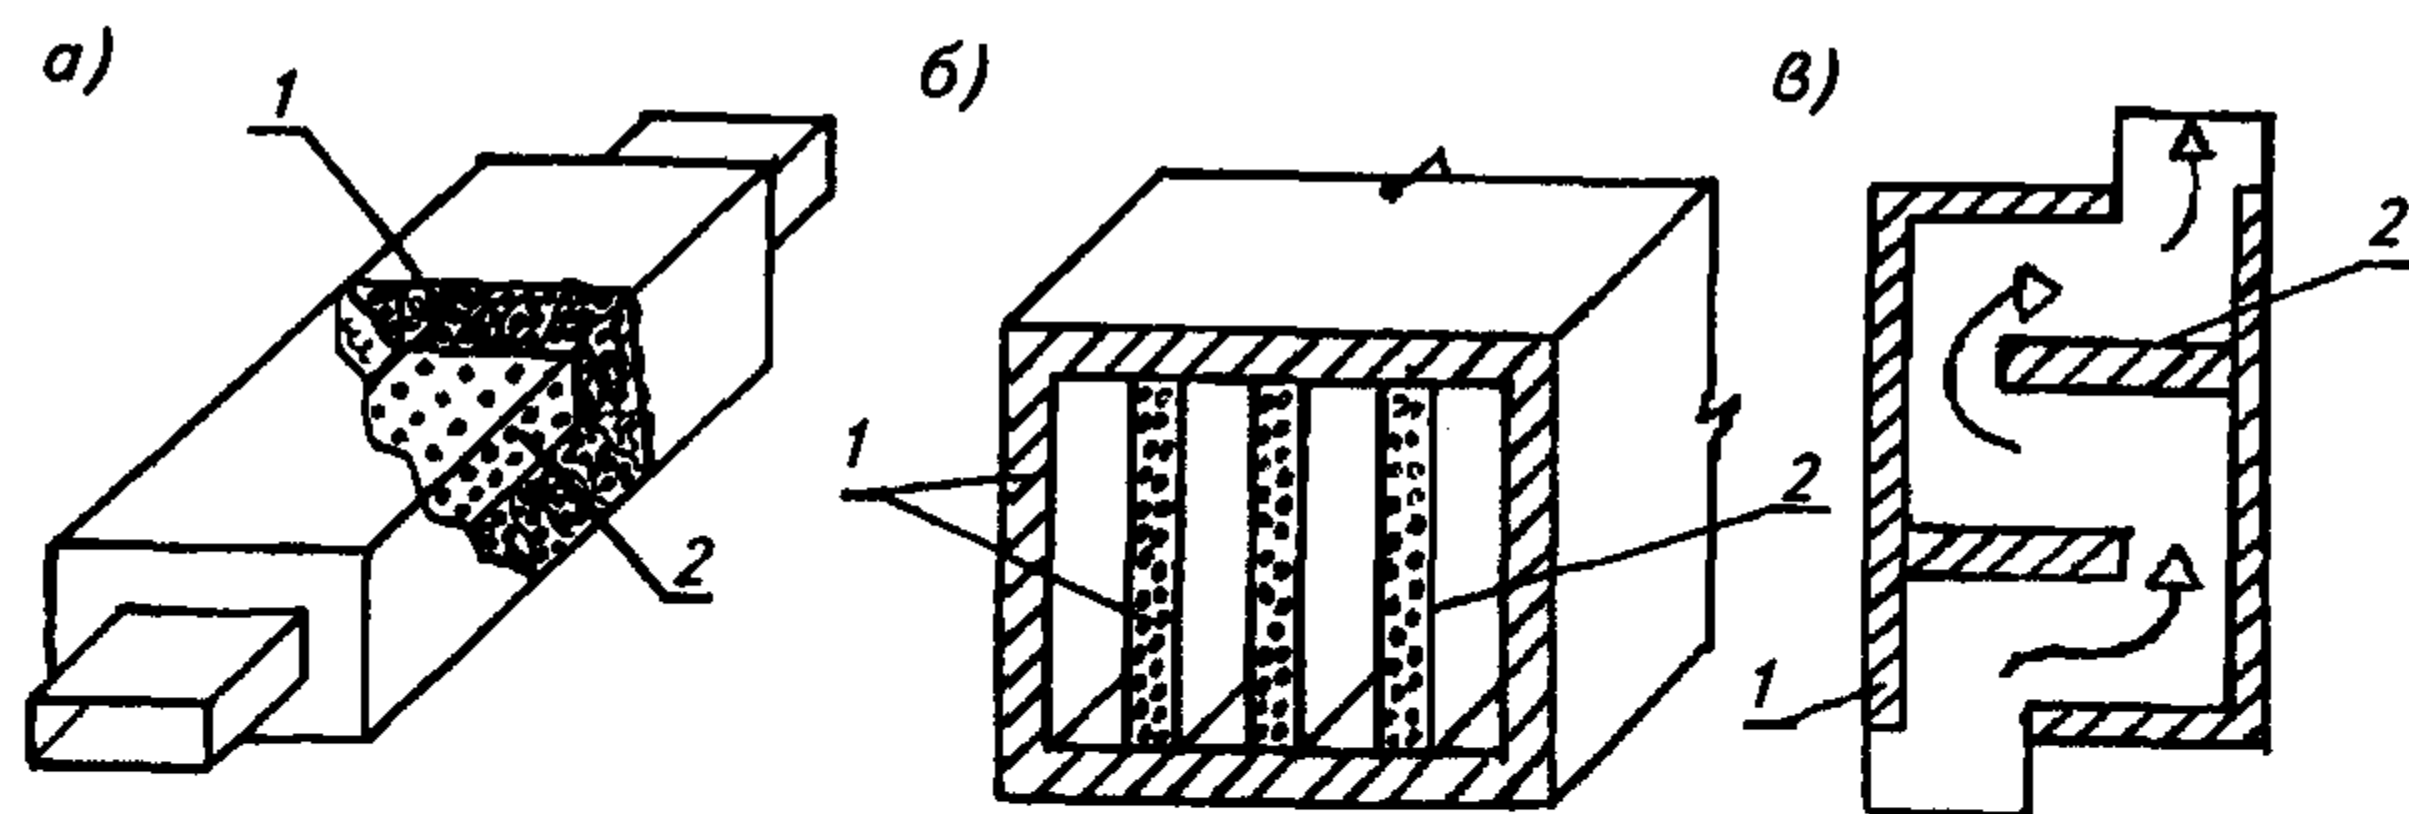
Шумоглушители: а — трубчатый; б — пластинчатый; в — камерный; 1 — звукопоглощающий материал; 2 — сетка или перфорированная оболочка
